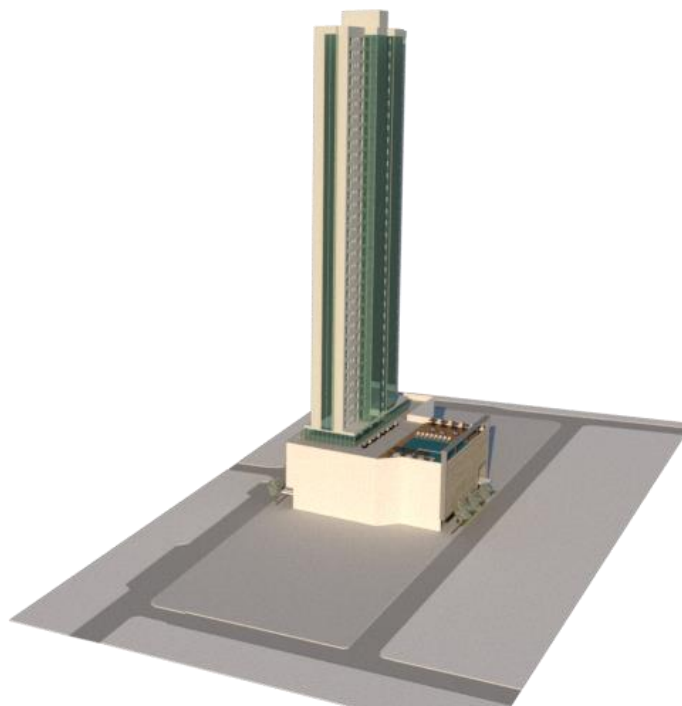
Fachada do empreendimento na Avenida Brasil.
